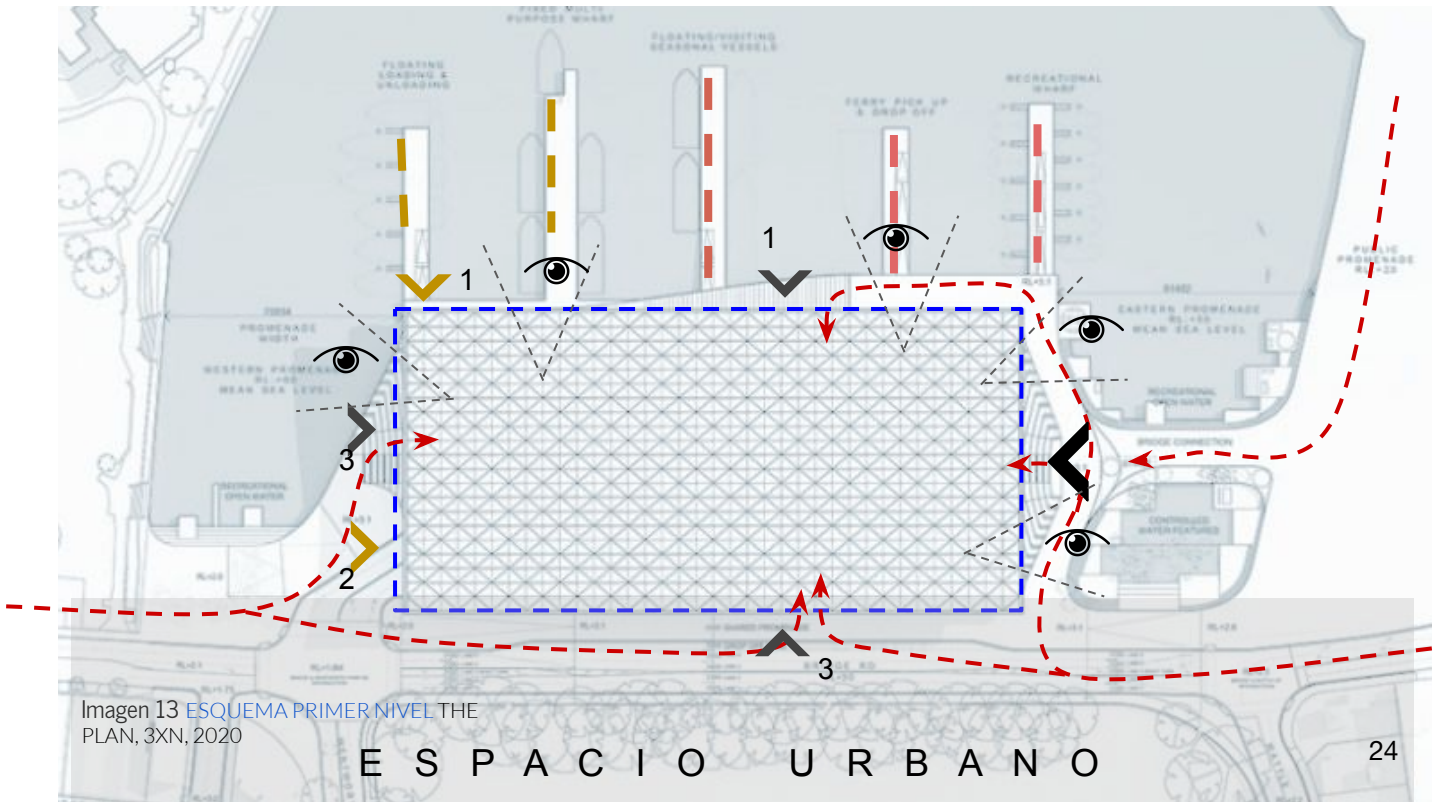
ESQUEMA PRIMER NIVEL THE PLAN, 3XN, 2020
